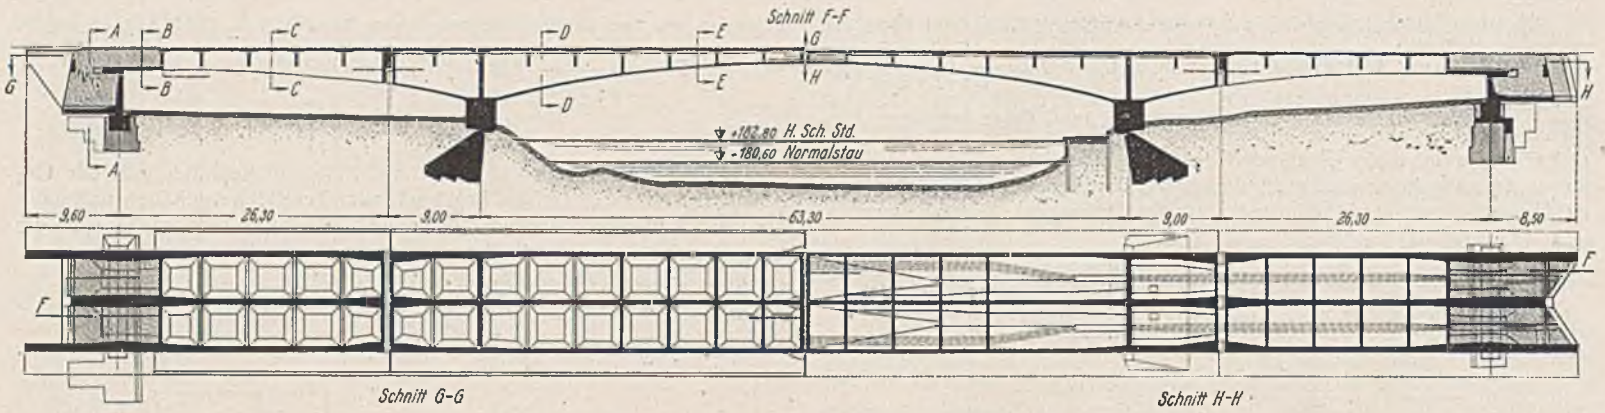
Längsschnitt, Untersicht und Grundriß der Brücke.
